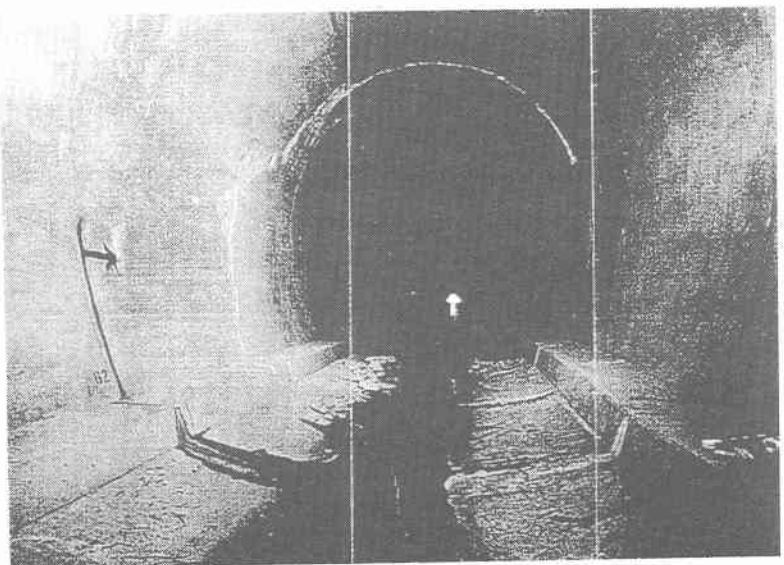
塩屋谷川放水路のリング状ひび割れ
